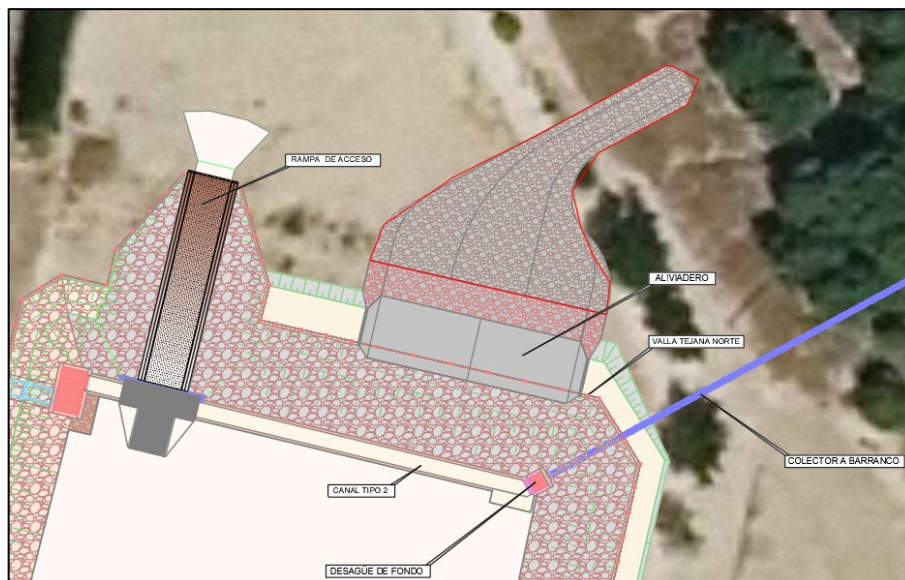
Vista en planta del aliviadero en la cerrada norte del depósito de tormentas.
